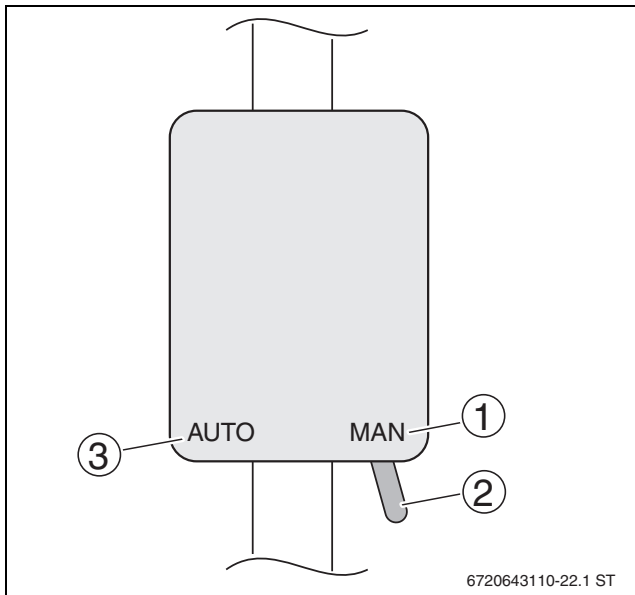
Zum Befüllen und Spülen das 2-Wege-Motorventil auf „MAN“ stellen
